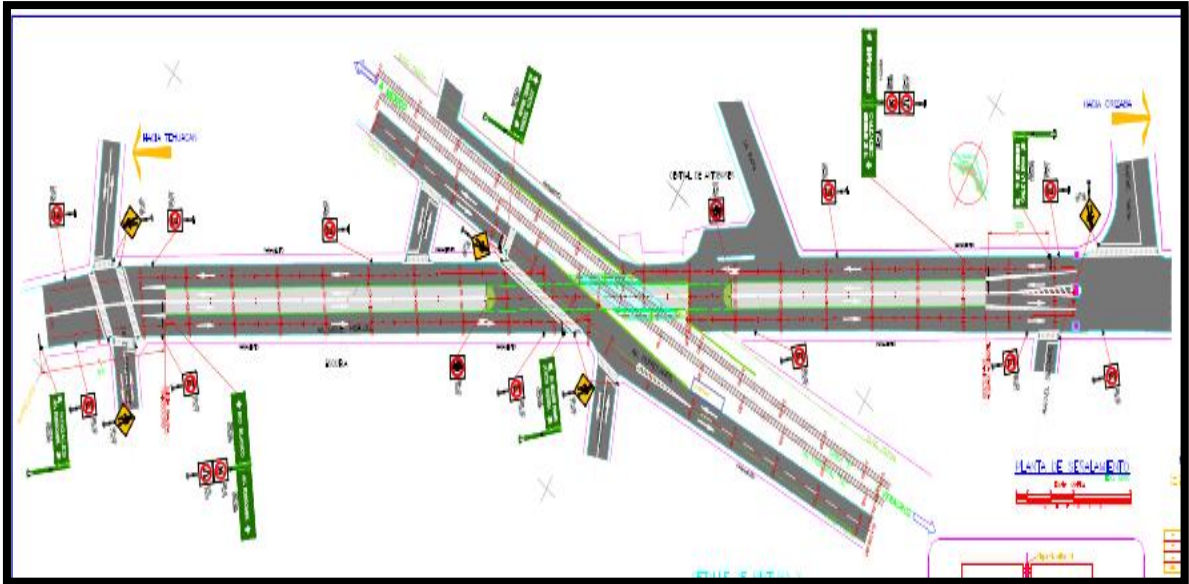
Plano de conjunto de señalamiento vertical y horizontal del PIV y F "Santa Rosa".
